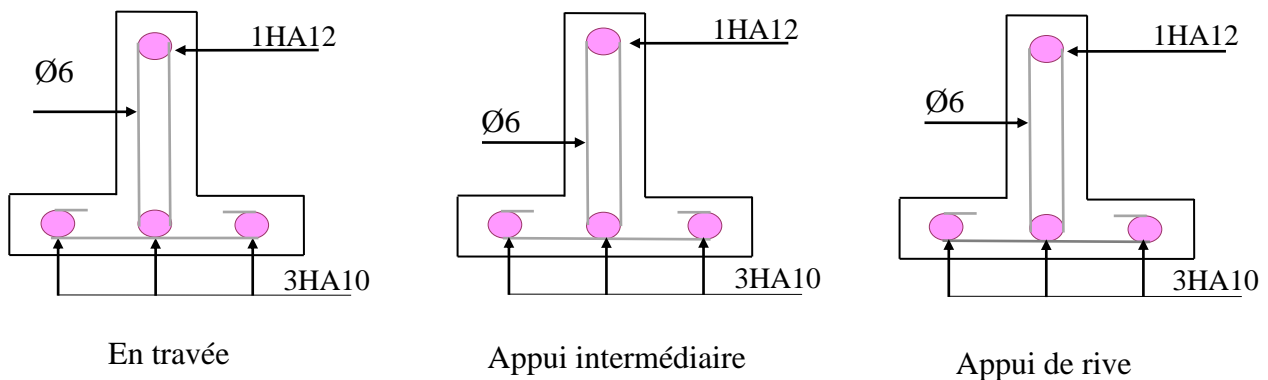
Schéma de Ferrailage des poutrelles plancher étage (Type1).
